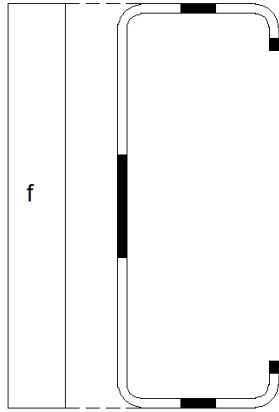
Sección efectiva de un perfil tipo C sometido a compresión. AutoCAD.
